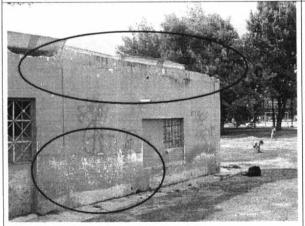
Fisuras superficiales y desprendimiento de acabados en algunos sectores al exterior del inmueble.
